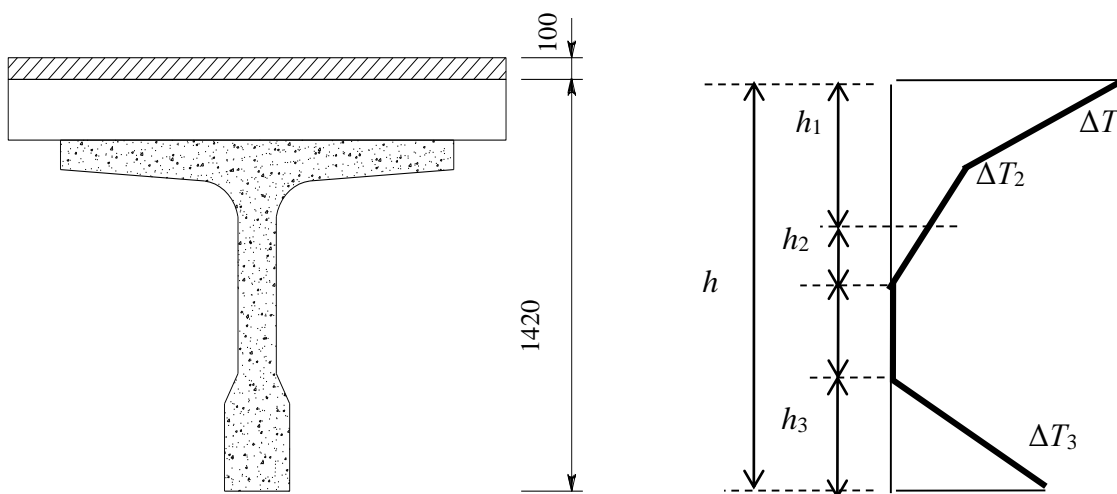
Схема поперечного сечения железобетонного моста (к примеру 7)
